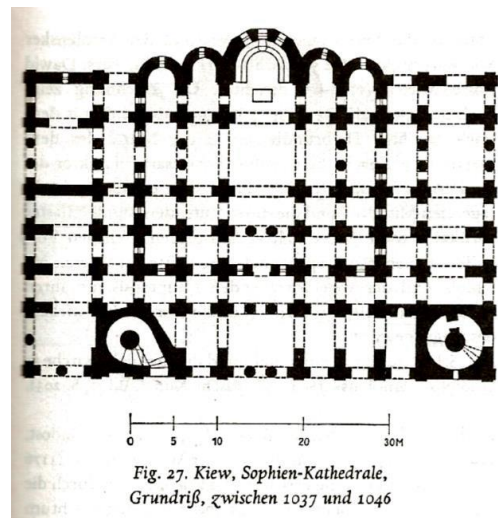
Sophienkathedrale in Kiew; Grundriss
